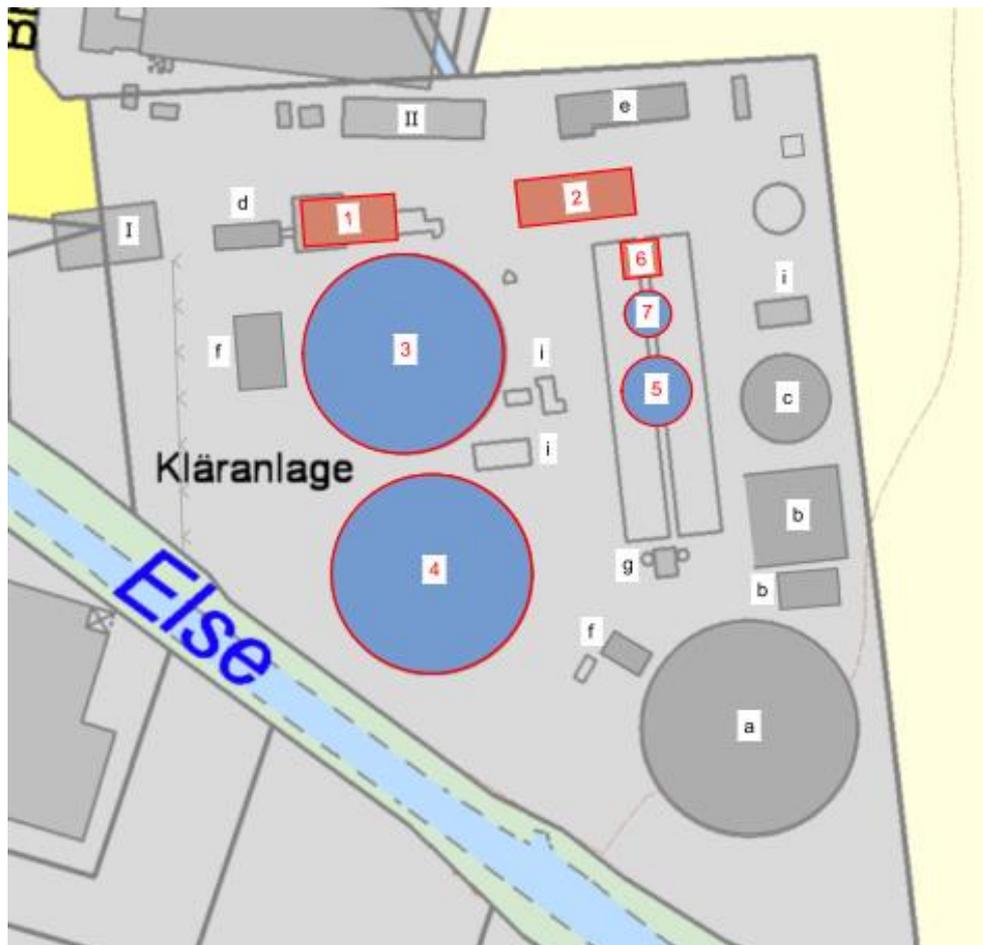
Lageplan Variante 4: Erweiterung KA Melle Mitte
